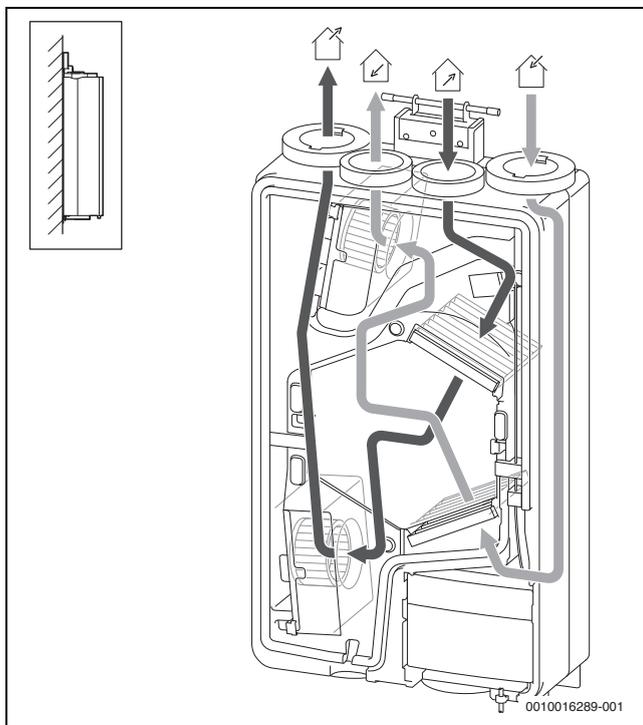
Collegamento dell'apparecchio lato aria per installazione a parete
